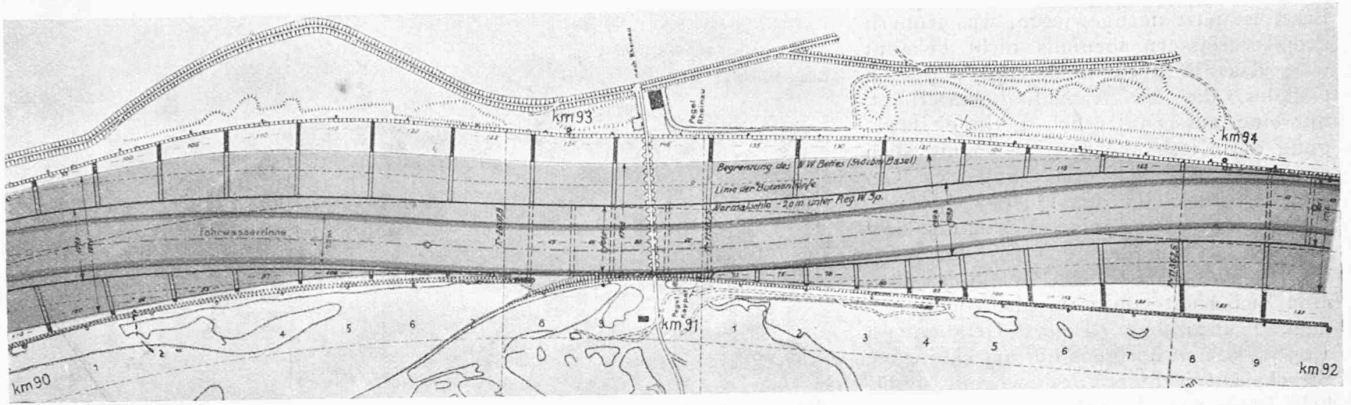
Grundriss der projektierten Bauwerke mit angestrebter Niederwasser-Sohle und Fahrwasserrinne zwischen Km. 90 und 92 (bei Kappel-Rheinau). — 1 : 10 000.
